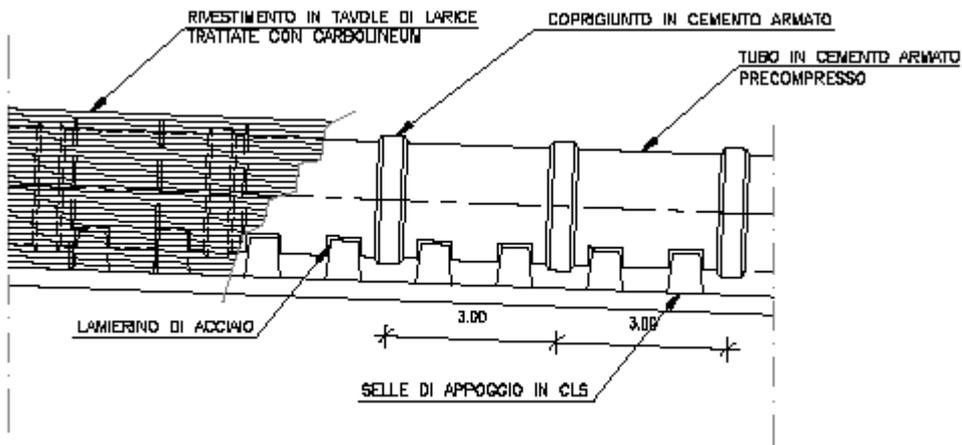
tratto all’aperto della condotta forzata in c.a.p.
